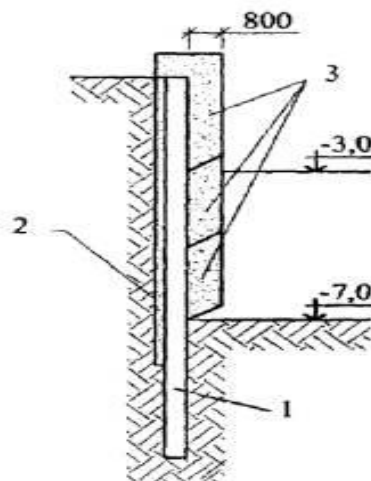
Конструкция стены подземного сооружения из 2-х рядов свай
